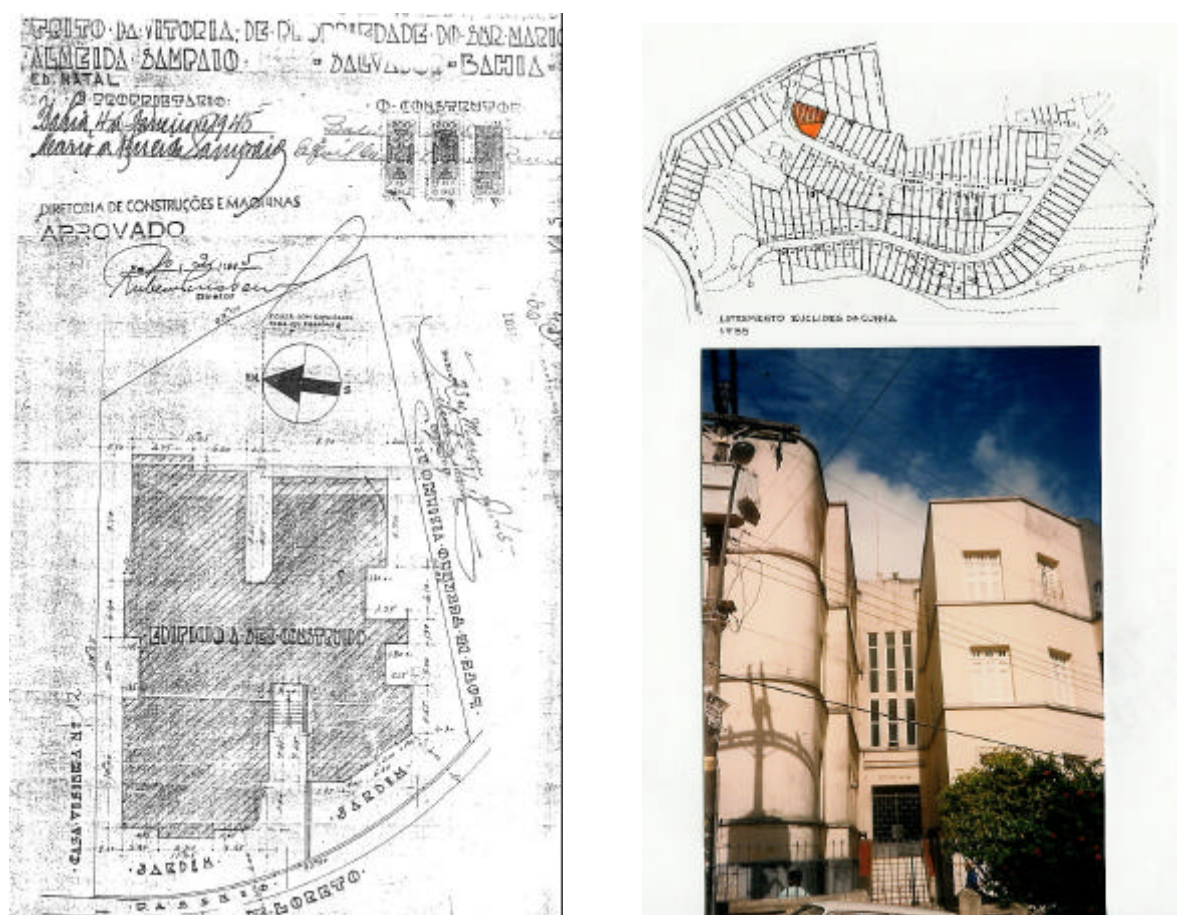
Planta de localização, de situação e entrada principal na fachada oeste, do Edifício Natal, situado na Graça.
